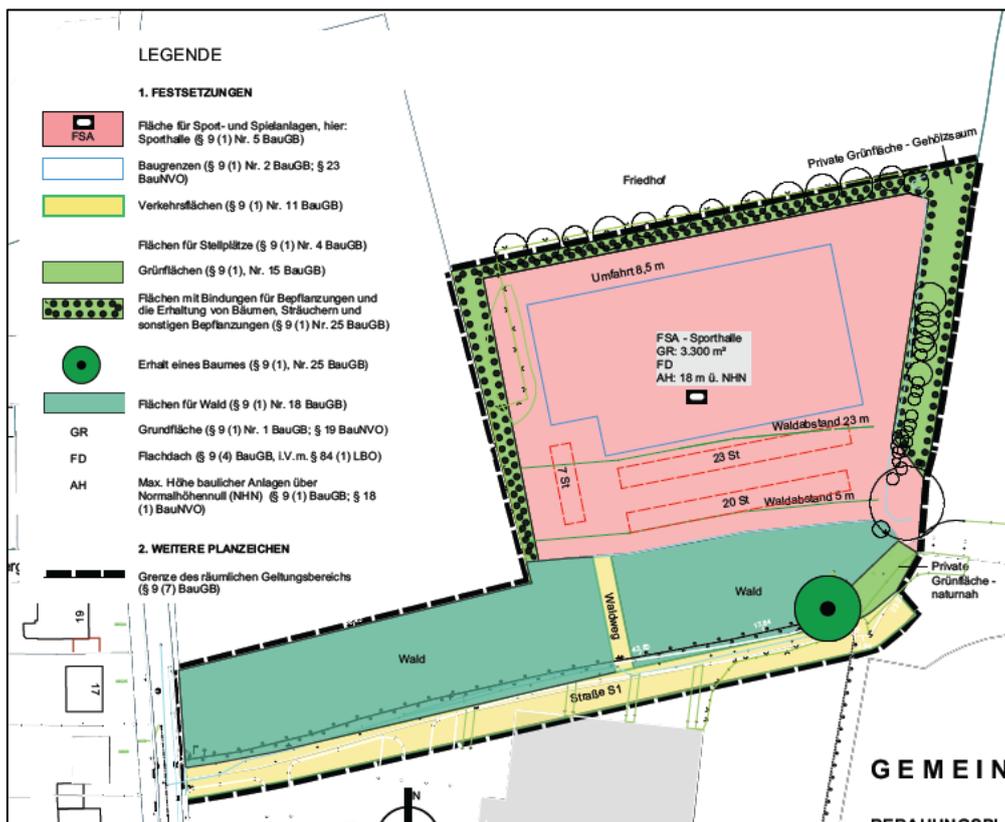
Planungsvorhaben B-Plan Nr. 71 (Auszug aus dem Entwurf zum B-Plan Nr. 71, Teil A - Planzeichnung, Stand 26.08.2019)
